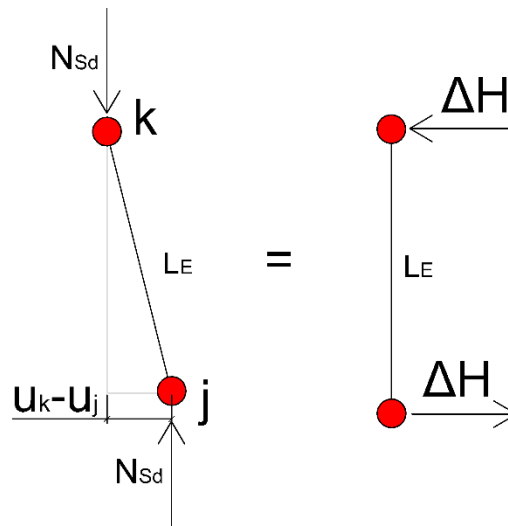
Pilar discretizado com elementos de pórtico (configurações indeformada e deformada)
